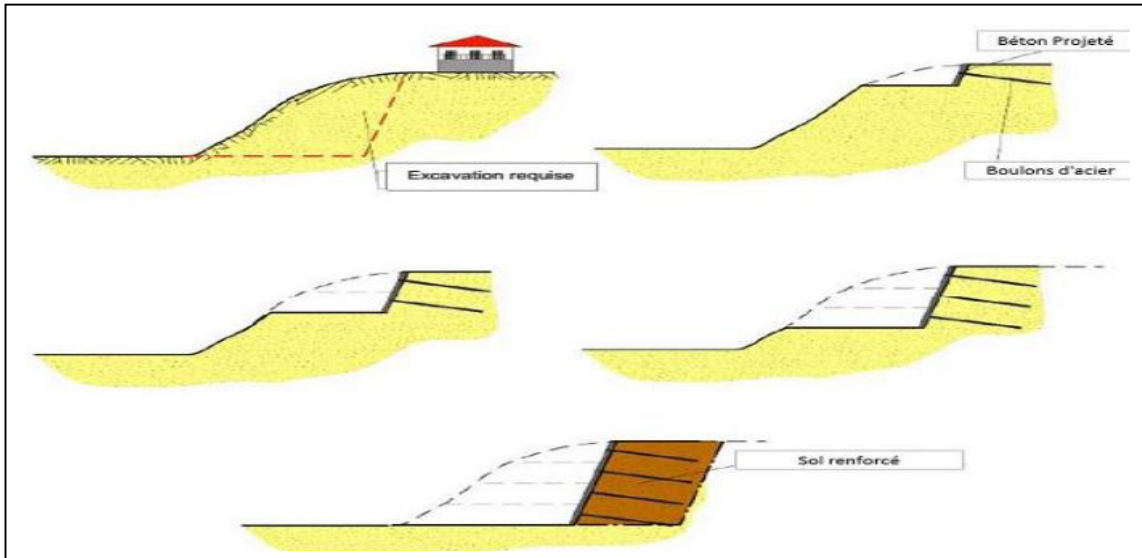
Schéma d'exécution de soutènement Soil Nailing
